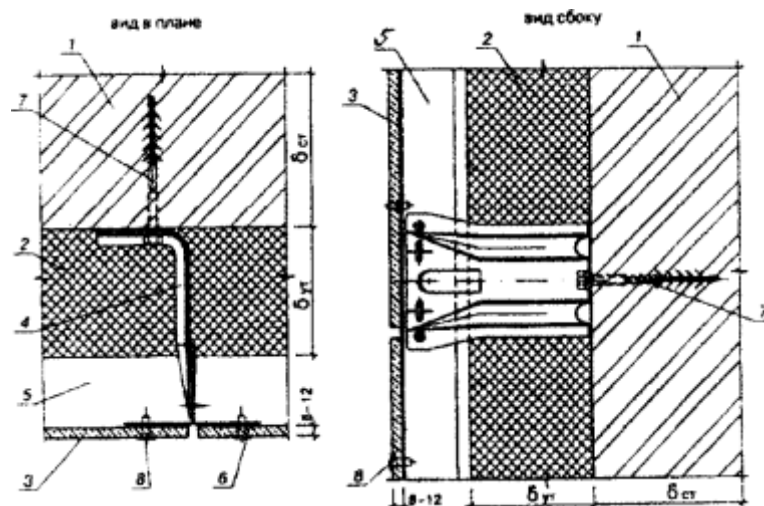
Наружное утепление стен с защитным экраном (стеклофибробетонные алиты): 1- утепляемая стена; 2 – утеплитель; 3 – облицовочные плиты; 4 – крепежный элемент; 5 – вентилируемый воздушный зазор; 5 вертикальный профиль из коррозионно-стойкого материала; 7 – дюбель; 8 – самонарезающие винты или заклепки.
